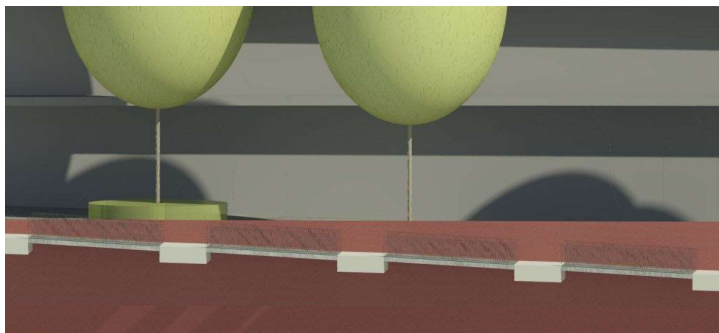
Modellierte Rampe Außenanlage Elbtower
